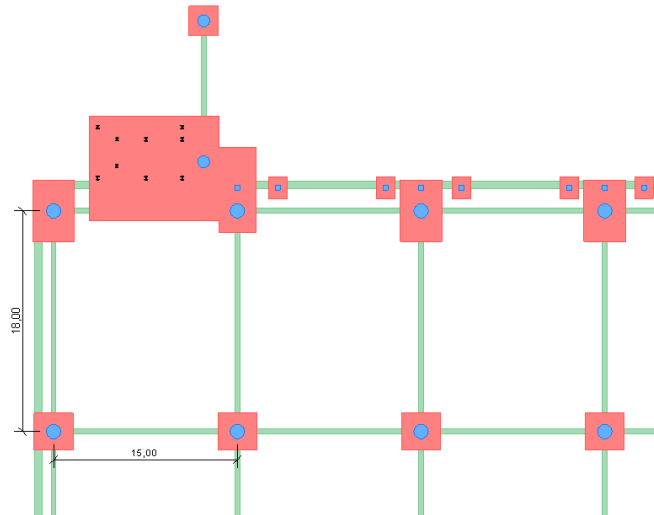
Detalle acotado de una de las crujías y sus pilares.
